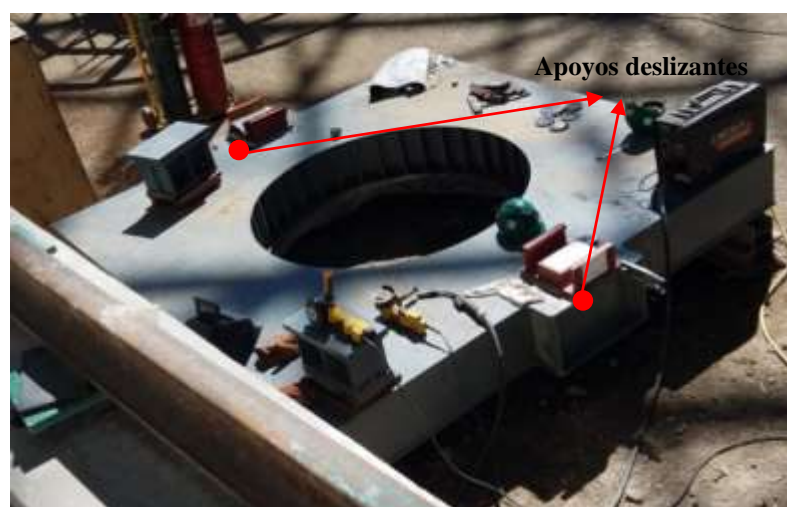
Soldadura de apoyos deslizantes
